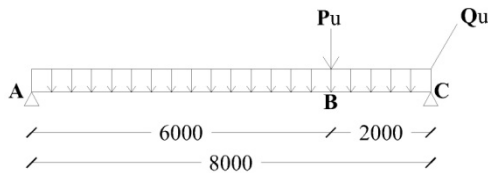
Balok anak lantai 2-10 yang ditinjau
